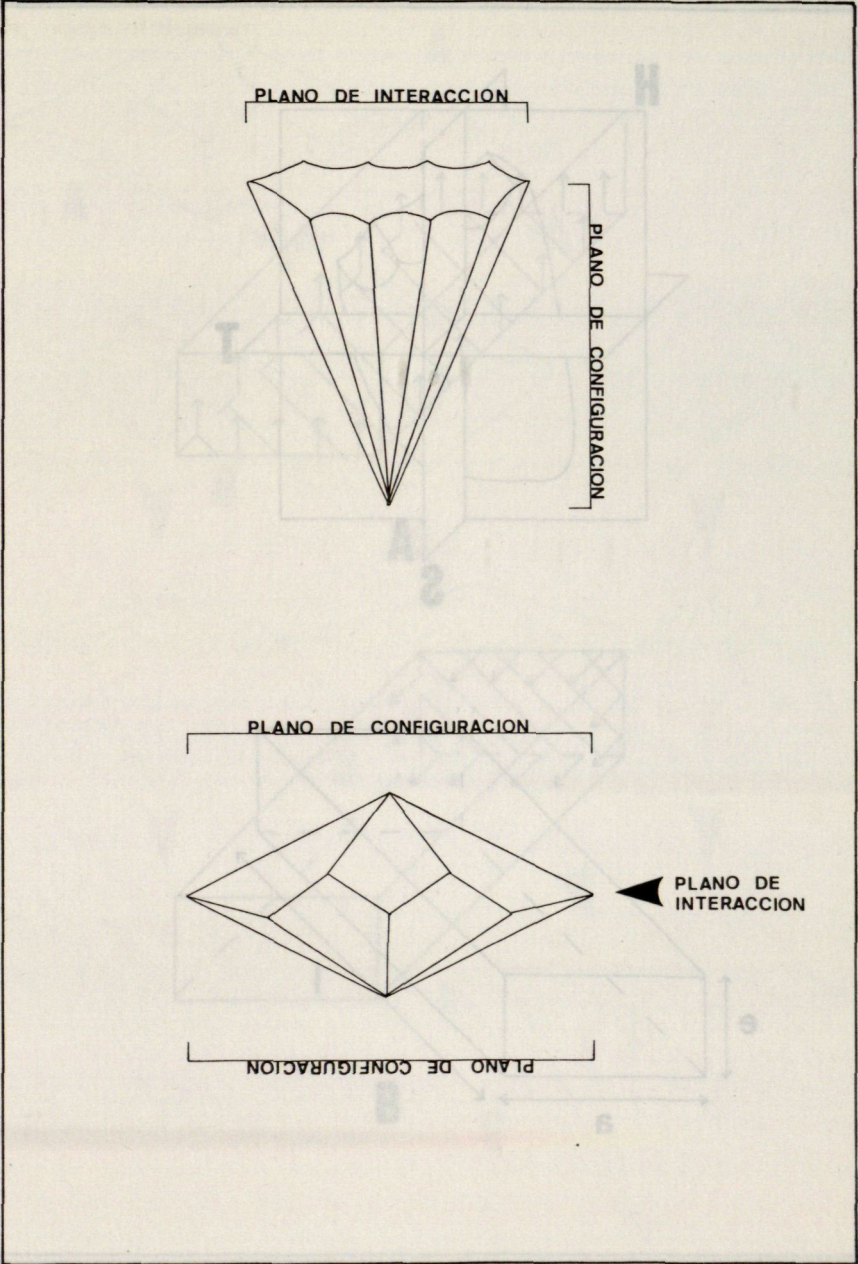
Elementos estructurales de una Base Negativa de Primera Generación: plano de interacción y plano de configuración.
